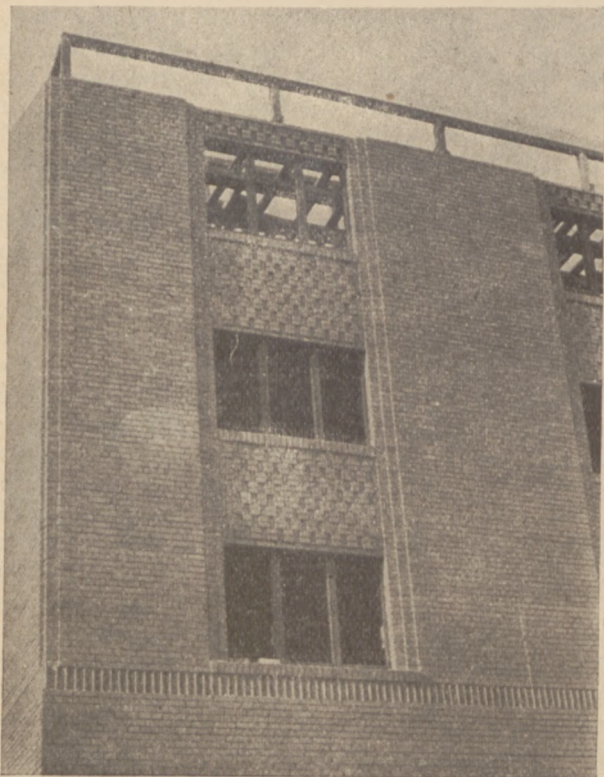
Ornamentyka murów parapetowych i pilastrów.
